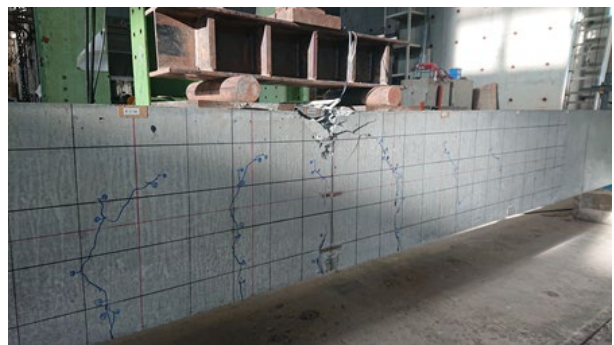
プレテンションPC試験体の曲げひび割れ性状
